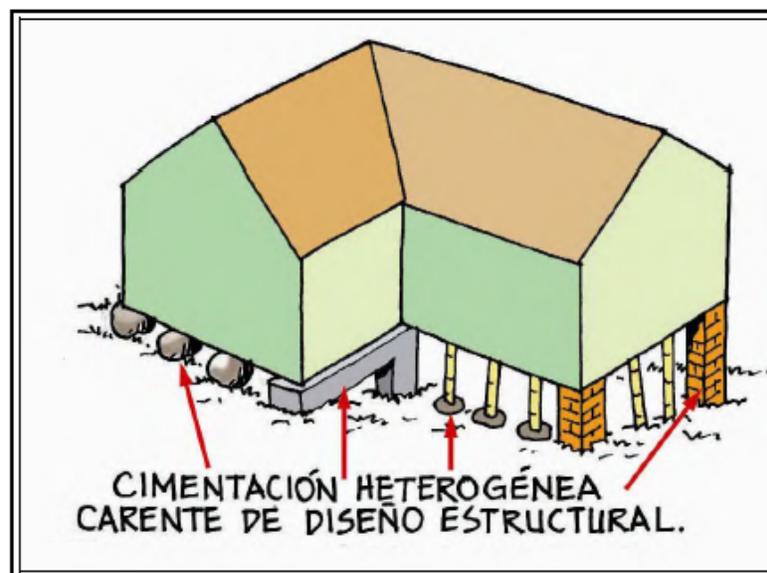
Tipos de cimentación encontrados. Fuente: AIS, 2002
